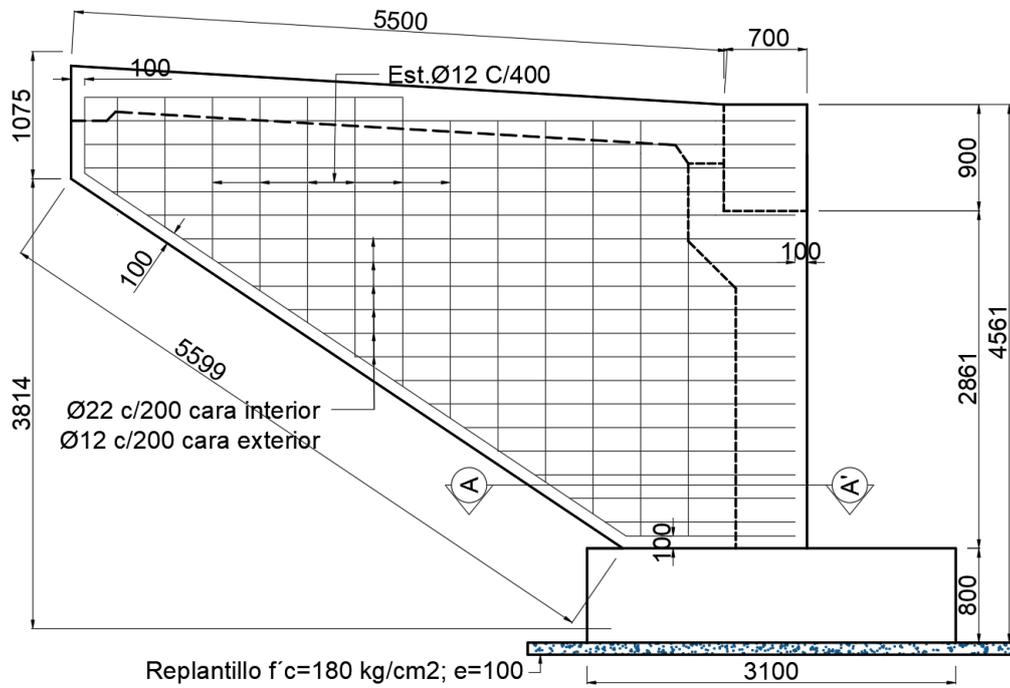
Armado de muro 1 [Elaboración propia]
